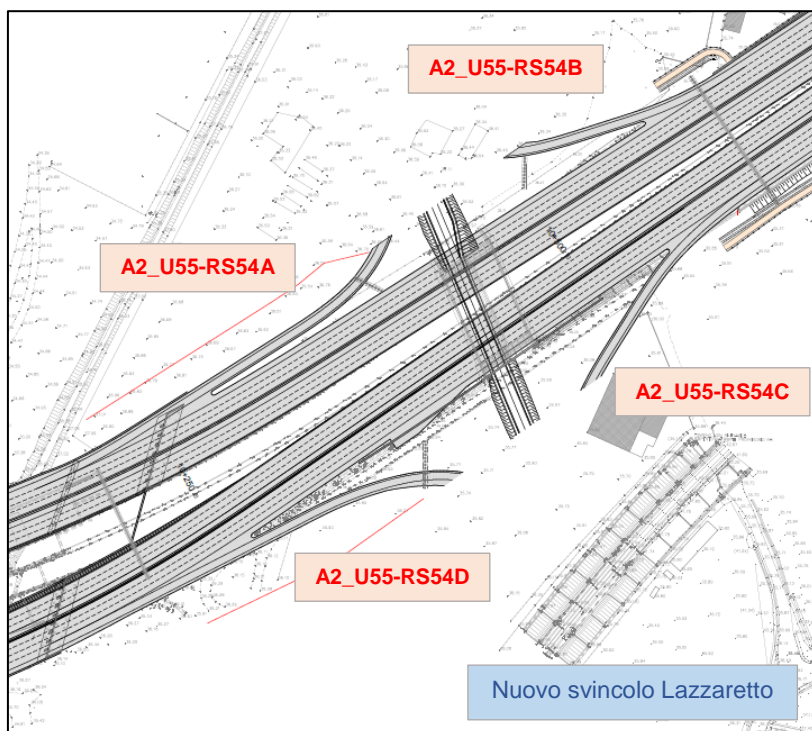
Stralcio planimetrico svincolo Lazzaretto
